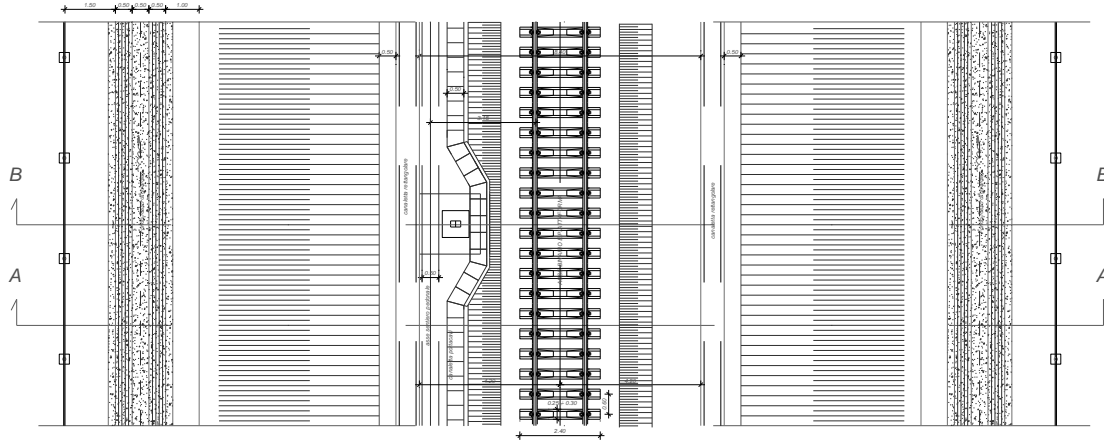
Stralcio planimetrico con sezione tipo ferroviaria in trincea a singolo binario in rettilo
